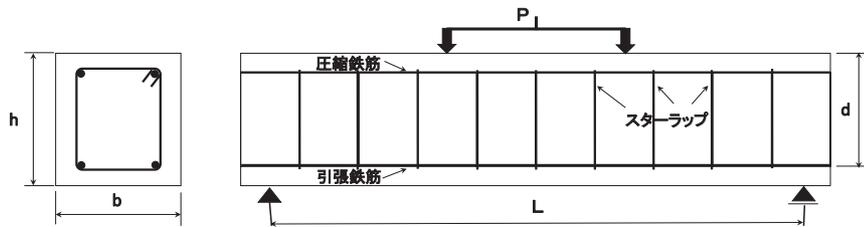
鉄筋コンクリート梁の断面、配筋および載荷状況
